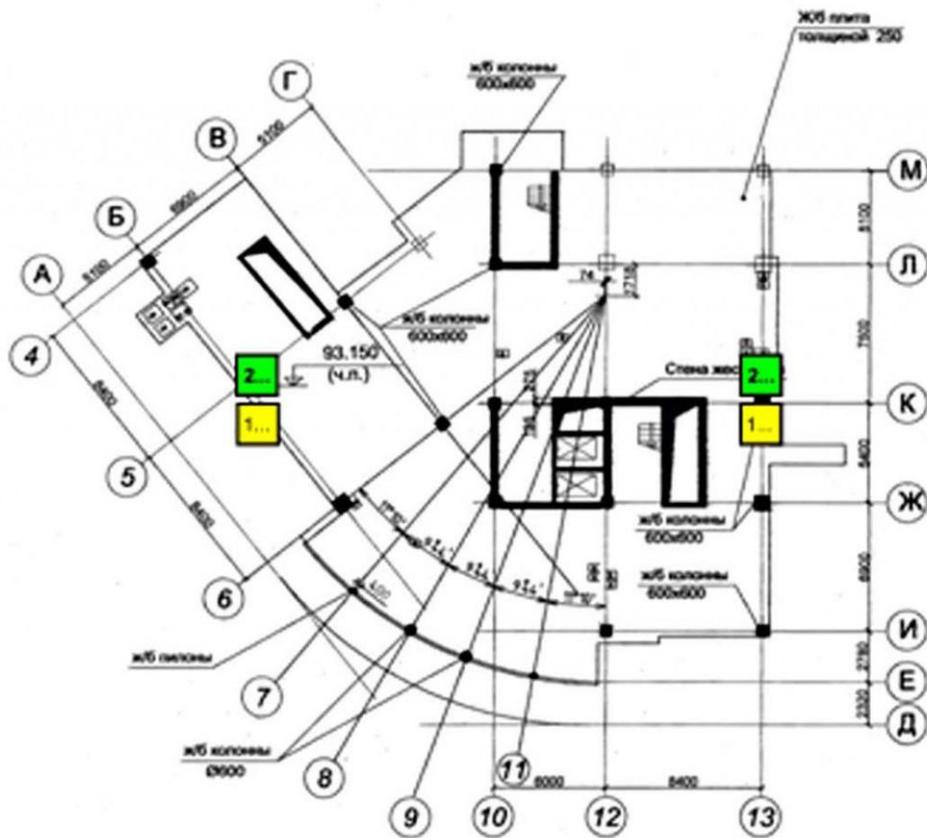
,б. Схема размещения измерительных пунктов на планах конструкций 27-го (на отм. 93.150 (ч.п.)) этажа высотного здания
